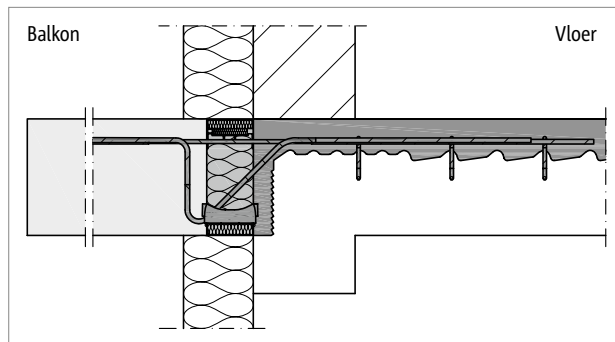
Schöck Isokorf® T type K-E: aansluiting bij spouwisolatie
